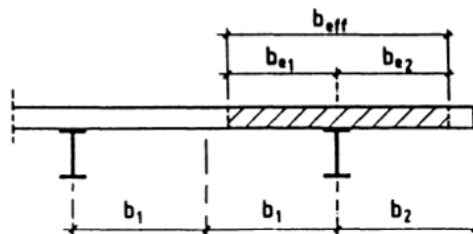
Cálculo del ancho eficaz del ala de hormigón
